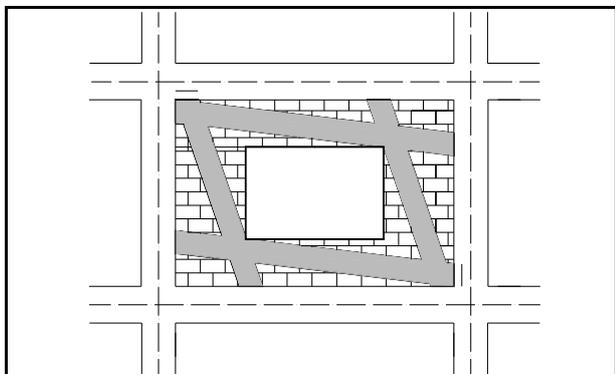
Sistema de escoras equivalentes adaptado a painel com abertura.
